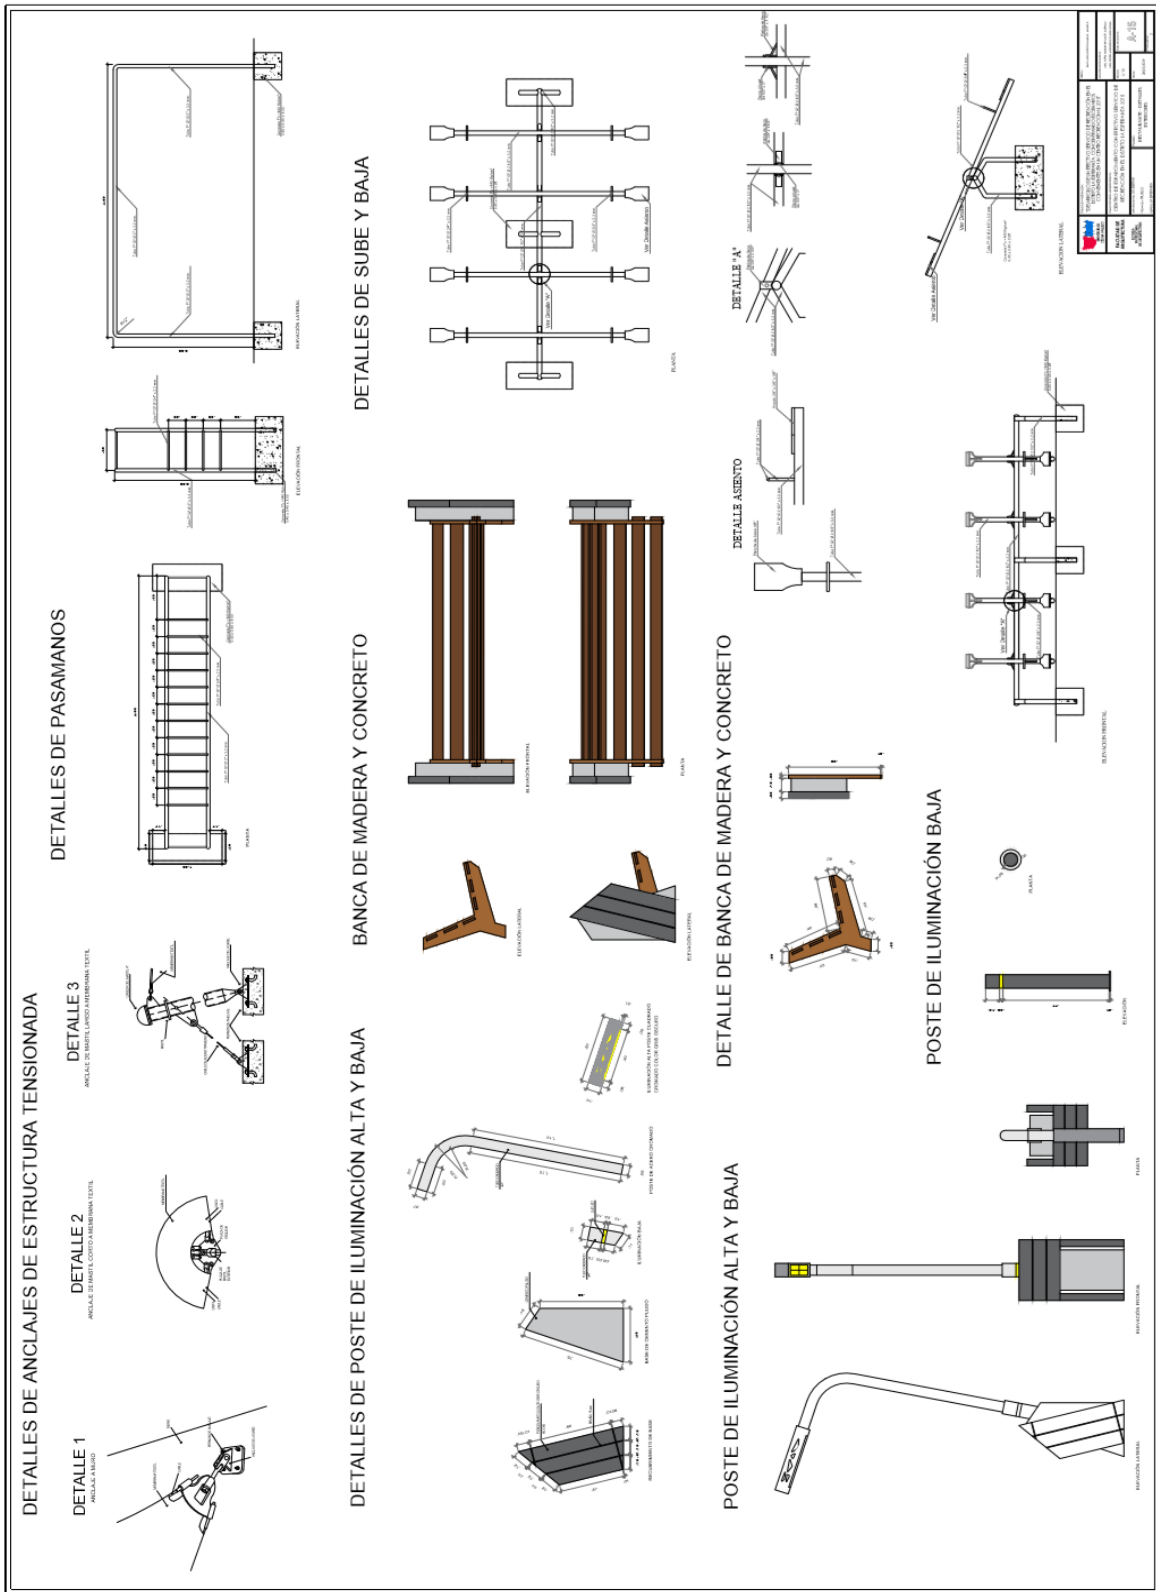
Plano de Detalles Exteriores. Elaboración propia.
